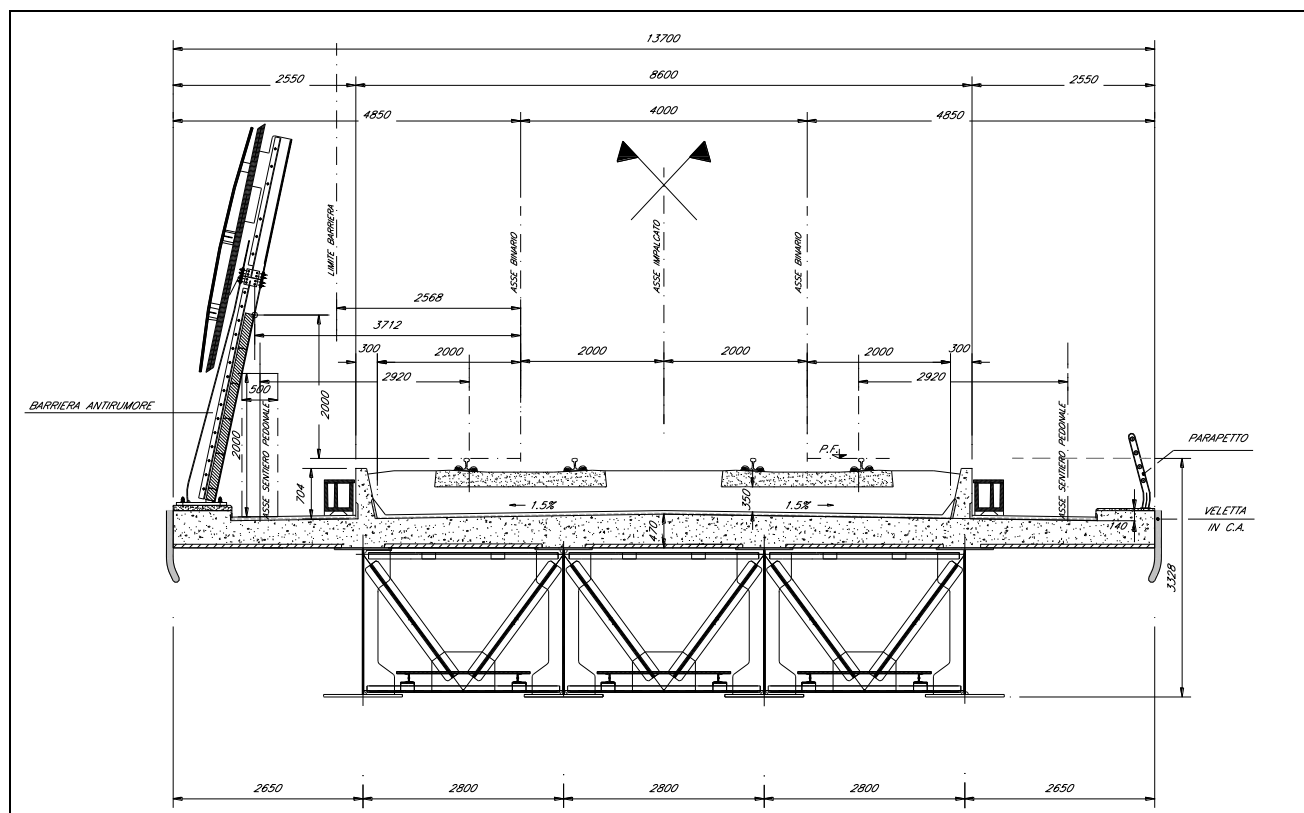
Sezione tipo impalcato misto acciaio-calcestruzzo. L=34.00m
